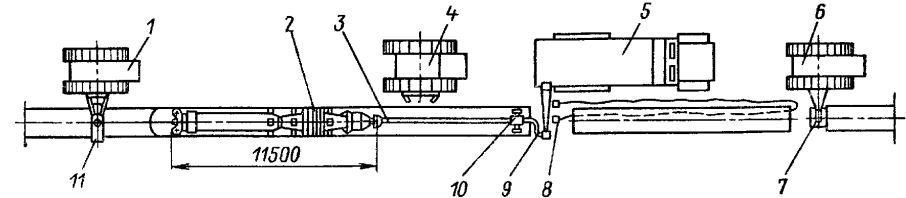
Схема сборки и сварки магистрального трубопровода с помощью внутритрубной машины:
